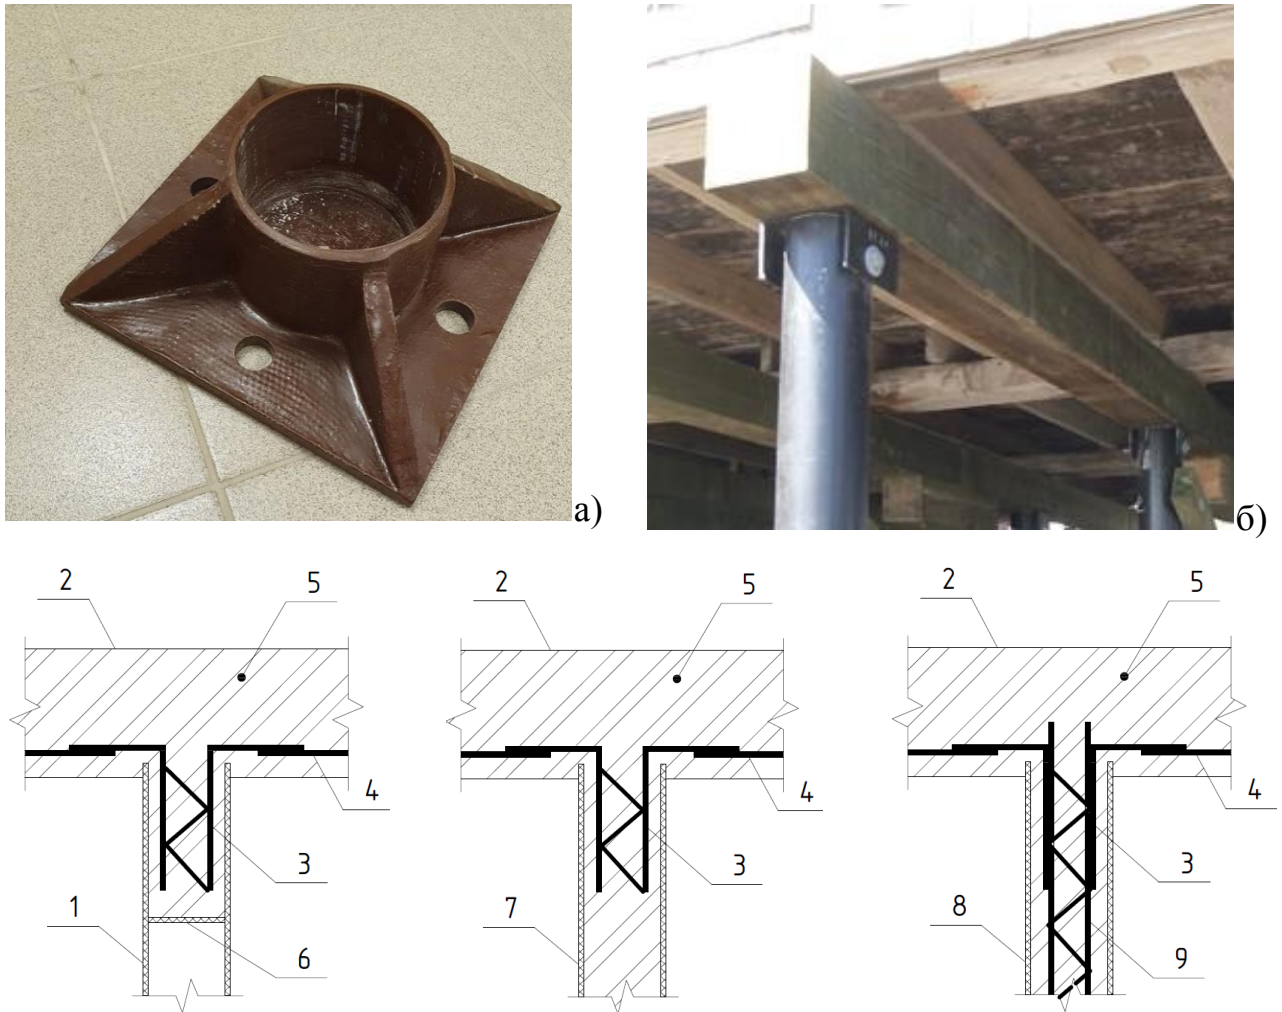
Варианты соединения композитных свай с надземными конструкциями
